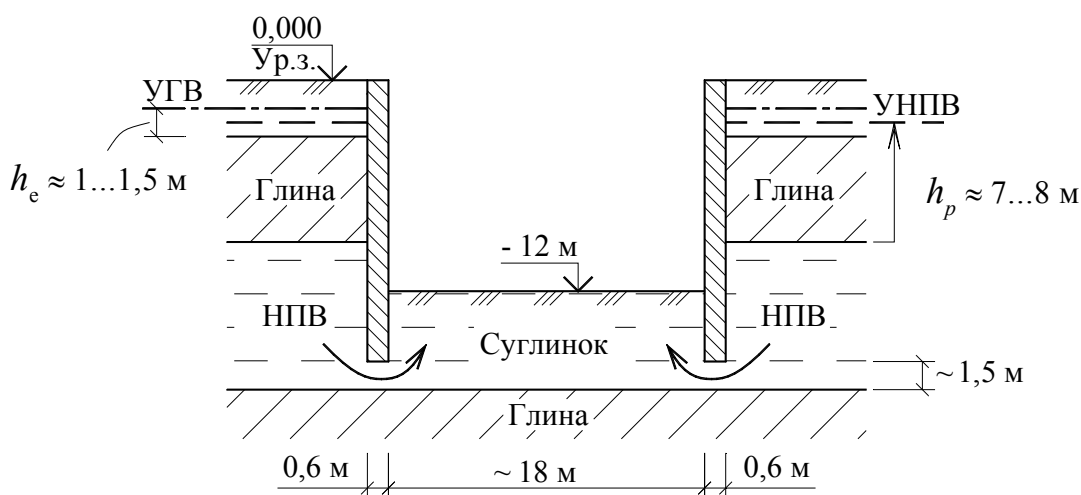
Схематичный гидрогеологический разрез со «стеной в грунте»
